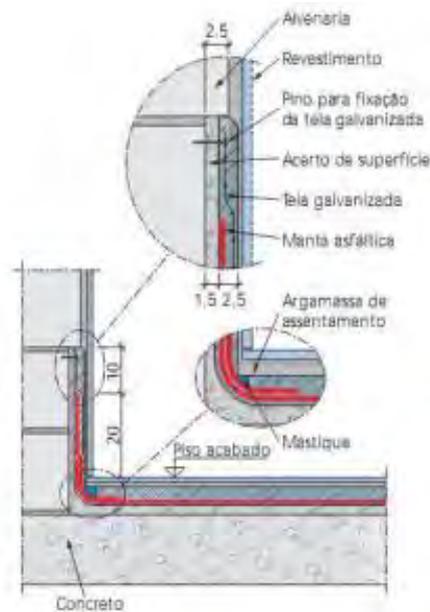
Detalhamento do encaixe da manta na alvenaria.
